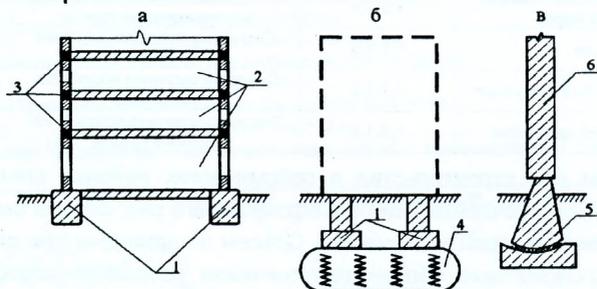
Виды антисейсмических мероприятий: а - устройство антисейсмических поясов; б - устройство демпферных подушек под фундаменты; в - устройство шарнирно-подвижных фундаментов; 1 - фундамент; 2 - этажи; 3 - антисейсмические пояса; 4 - демпферные подушки; 5 - шарнирно-подвижный фундамент; 6 - стена здания.
